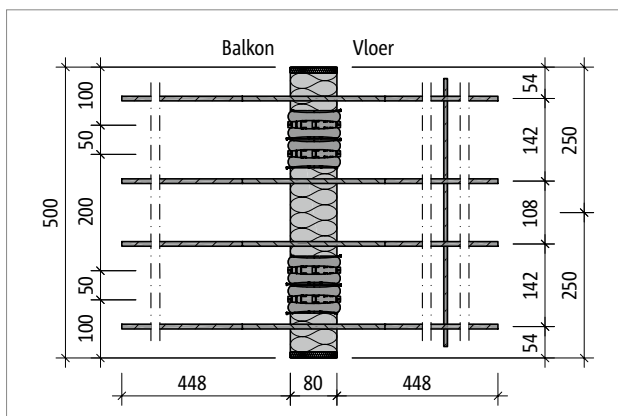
Schöck Isokorb® T type Q-E-V4: Bovenaanzicht
